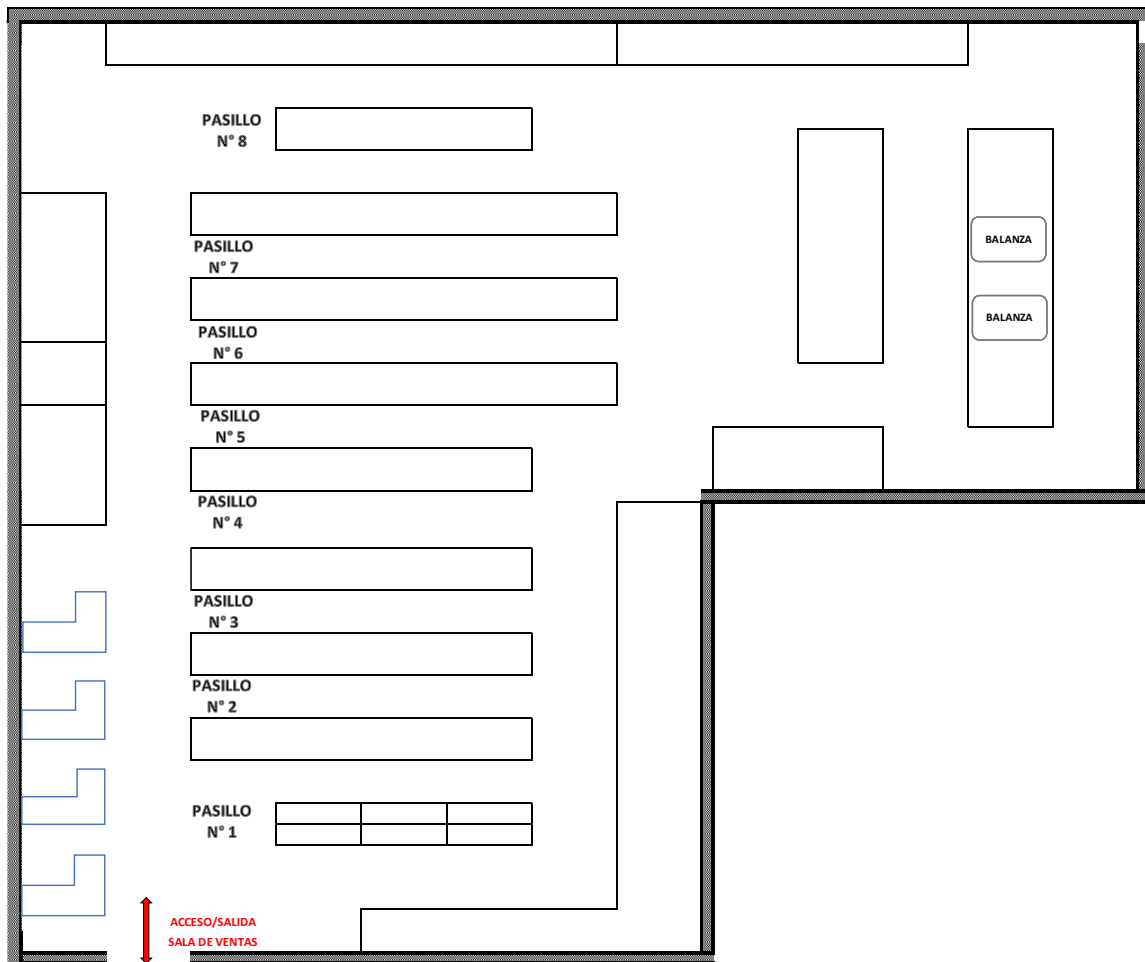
Plano layout zona de ventas Supermercado Zamora Centro.
